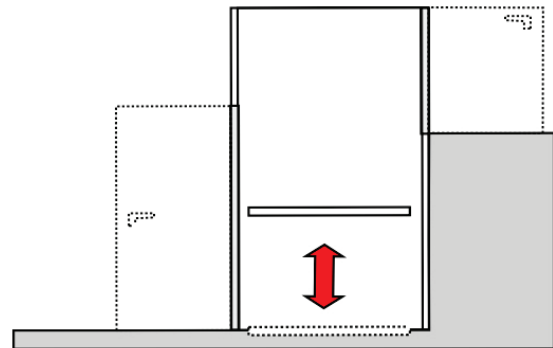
Prinzipskizze Plattformaufzug mit Schacht (halber Schachtkopf)
